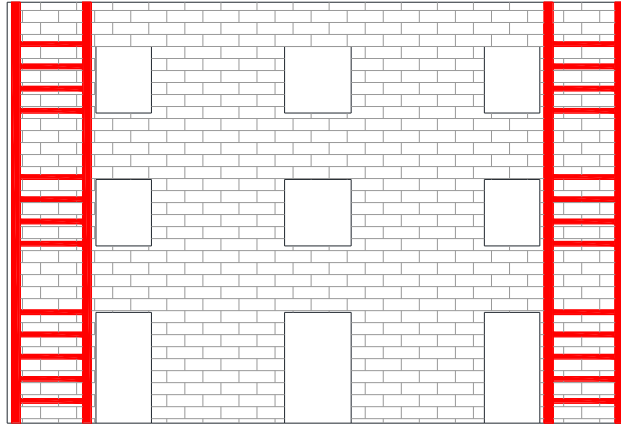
schema della disposizione del sistema di rinforzo FRP per la parete oggetto di studio.
